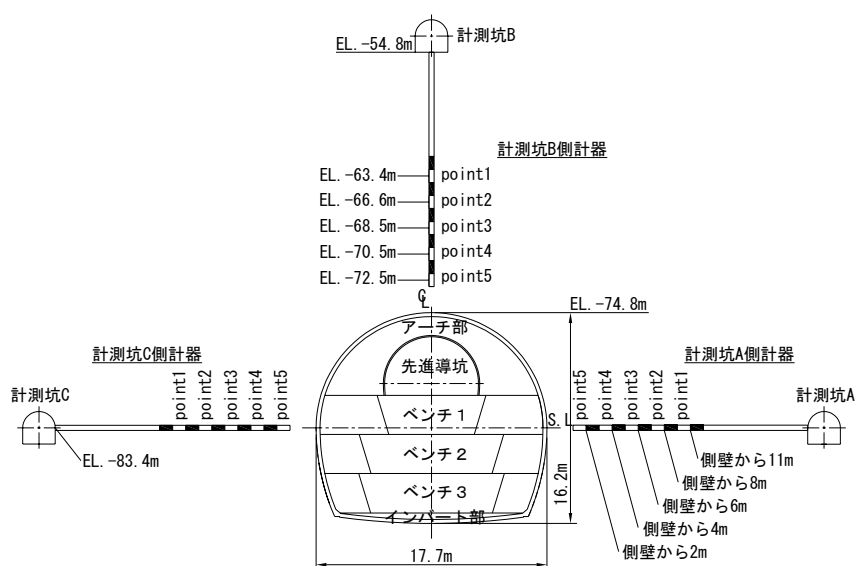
試験空洞の間隙水圧測定位置（①，②断面図）
